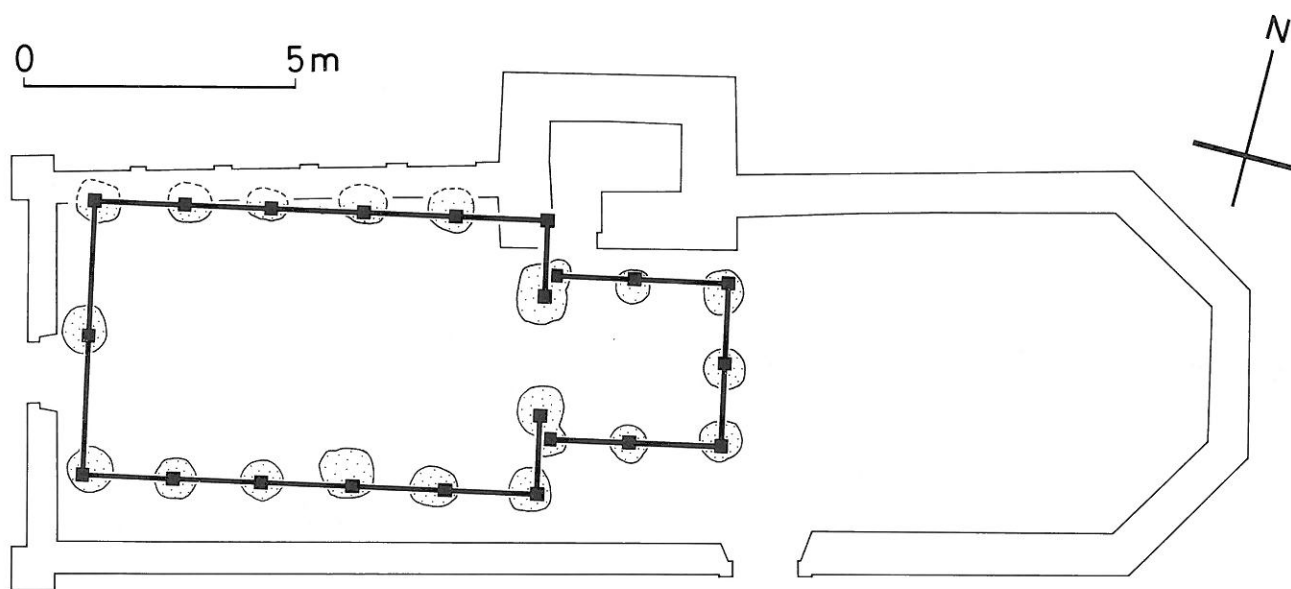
Der rekonstruierte Grundriss der Anlage I. M. 1:140
